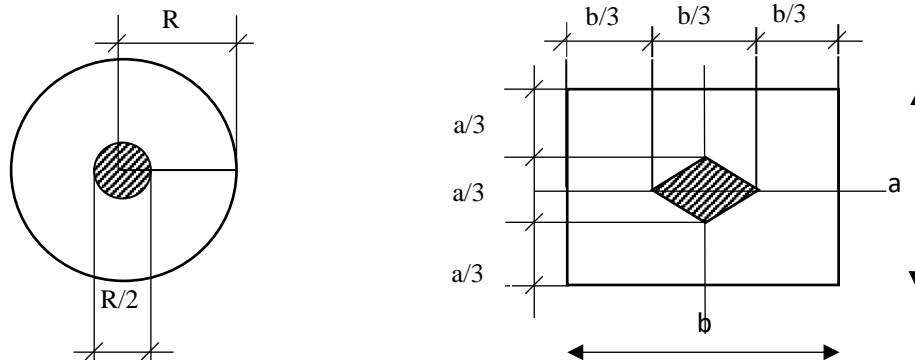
Dimensions du noyau central, cas d'une section circulaire et cas d'une section rectangulaire
